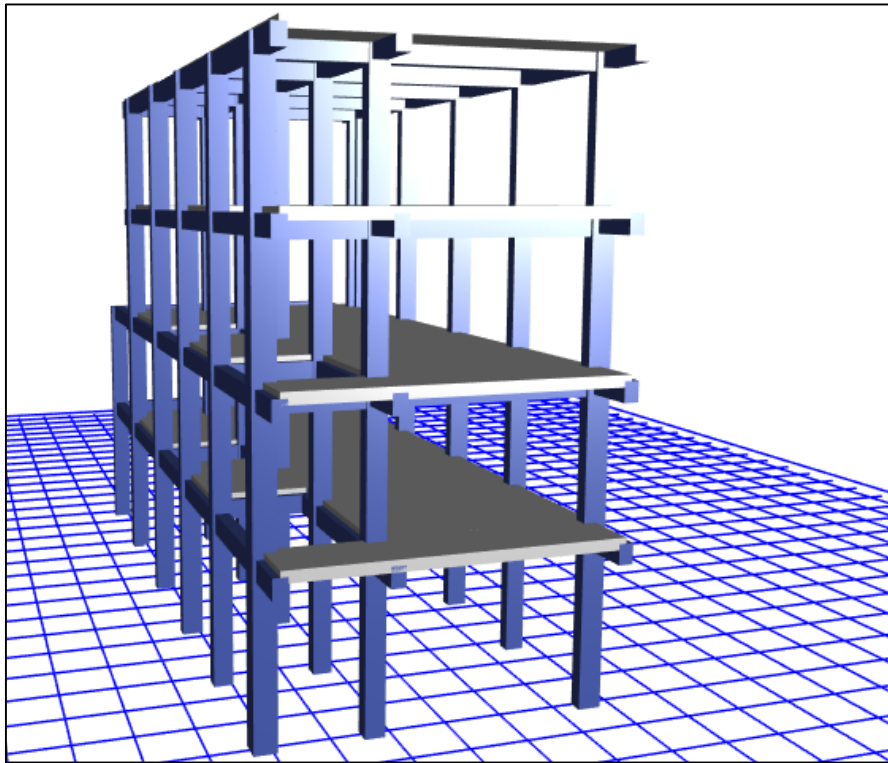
Vista renderizada del modelo 1, con vigas de sección constante.
